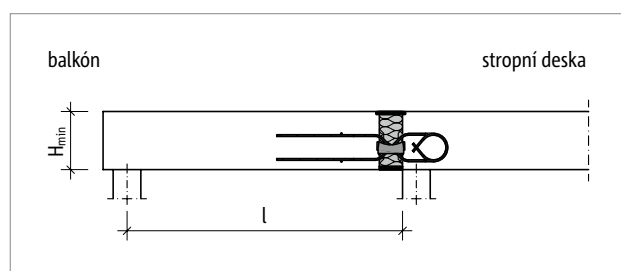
Schöck Isokorb® T typ QL-V1: Statický systém
